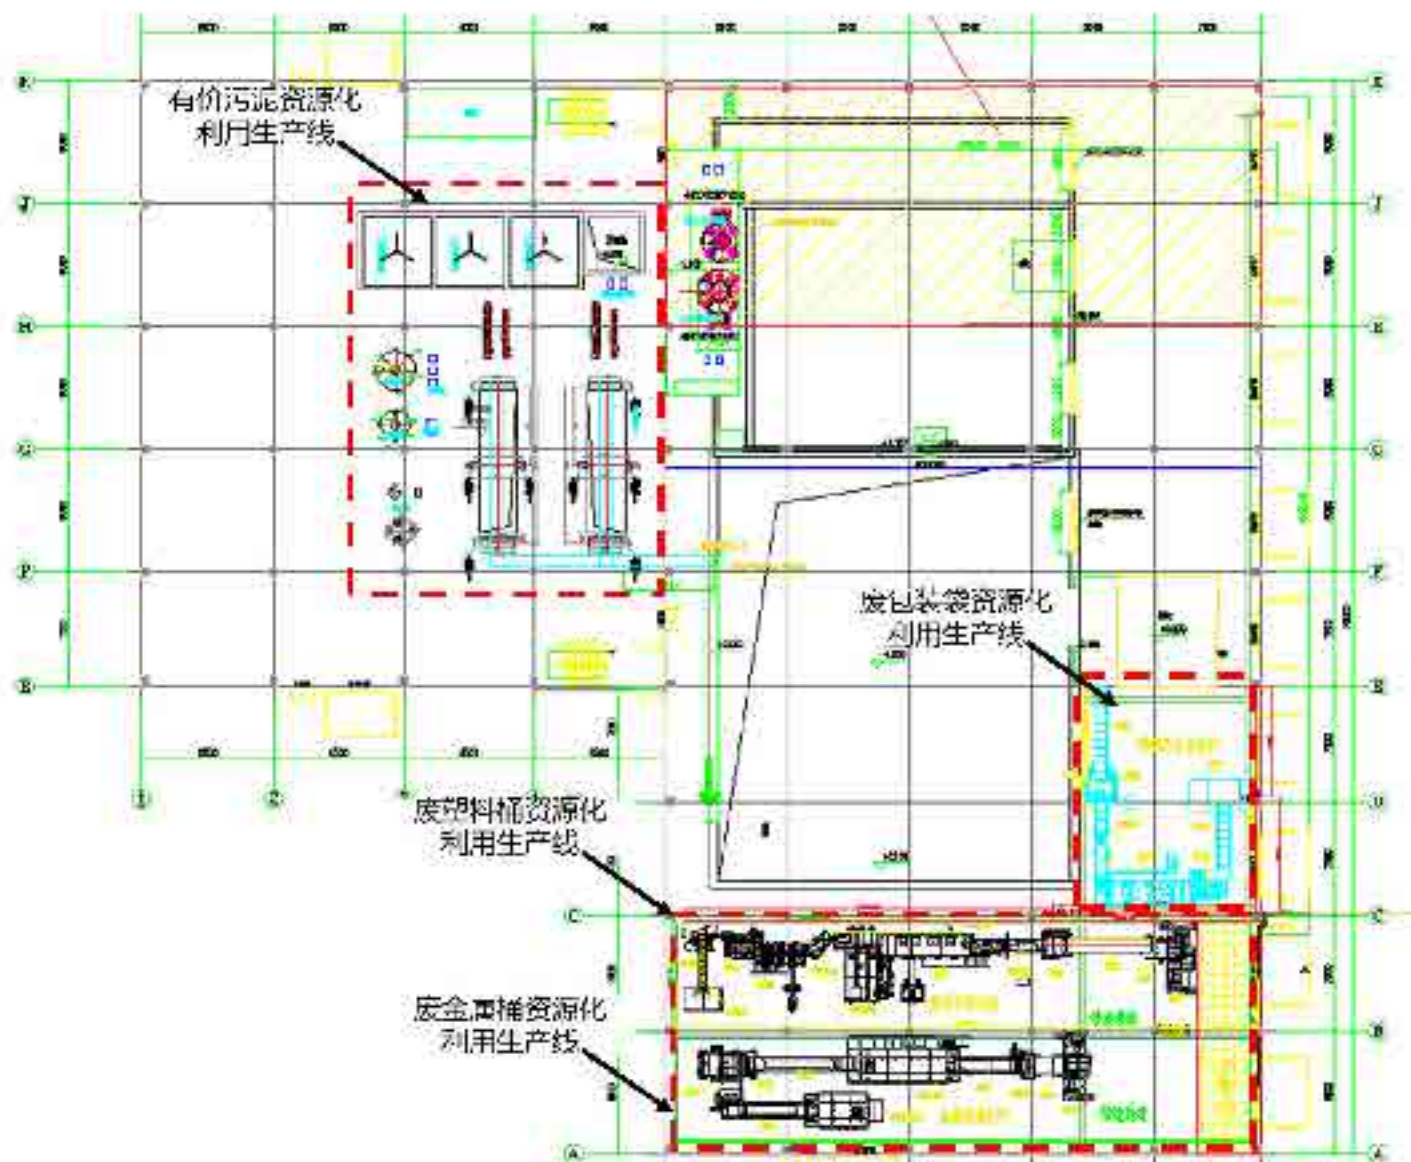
本项目（高价污泥、废包装物资源化利用生产线）平面布置图
